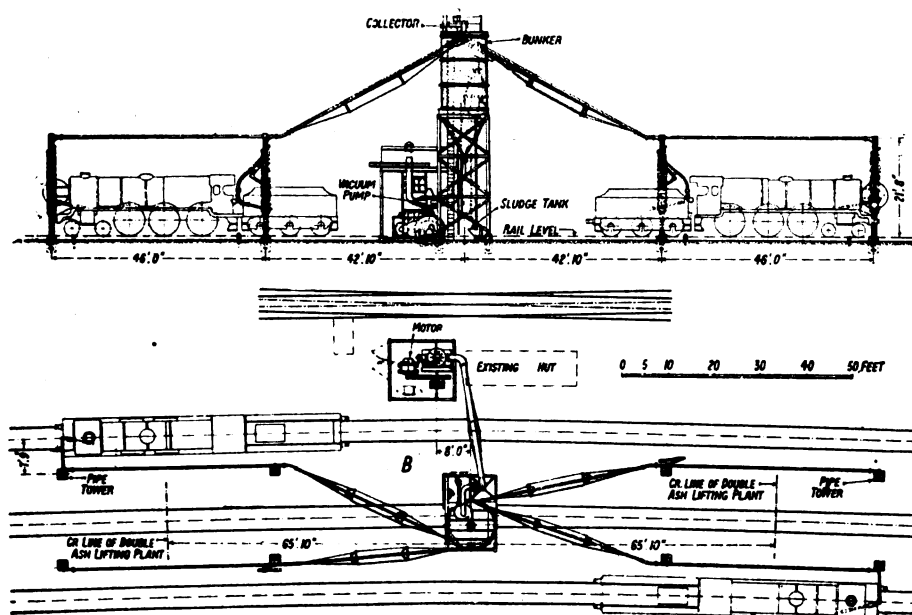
Sezione e pianta della disposizione generale dell'impianto di estrazione pneumatica delle ceneri dalle locomotive.
